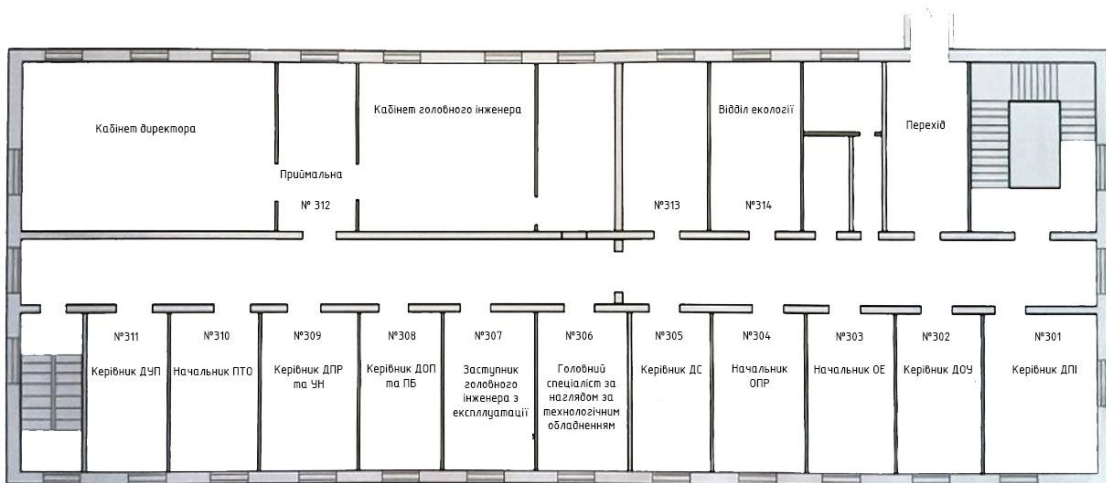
Кабінети службового корпусу. IV поверх.
